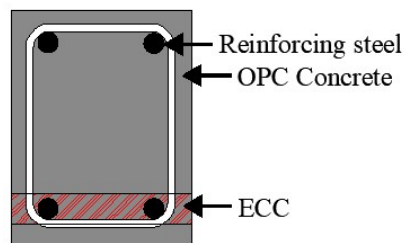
Konsep perkuatan balok beton bertulang dengan lapisan ECC pada daerah tarik balok.
